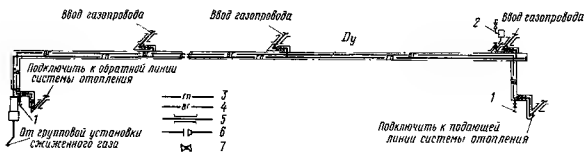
Схема наружных газопроводов с теплоизоляцией вдоль наружной стены жилого дома.
